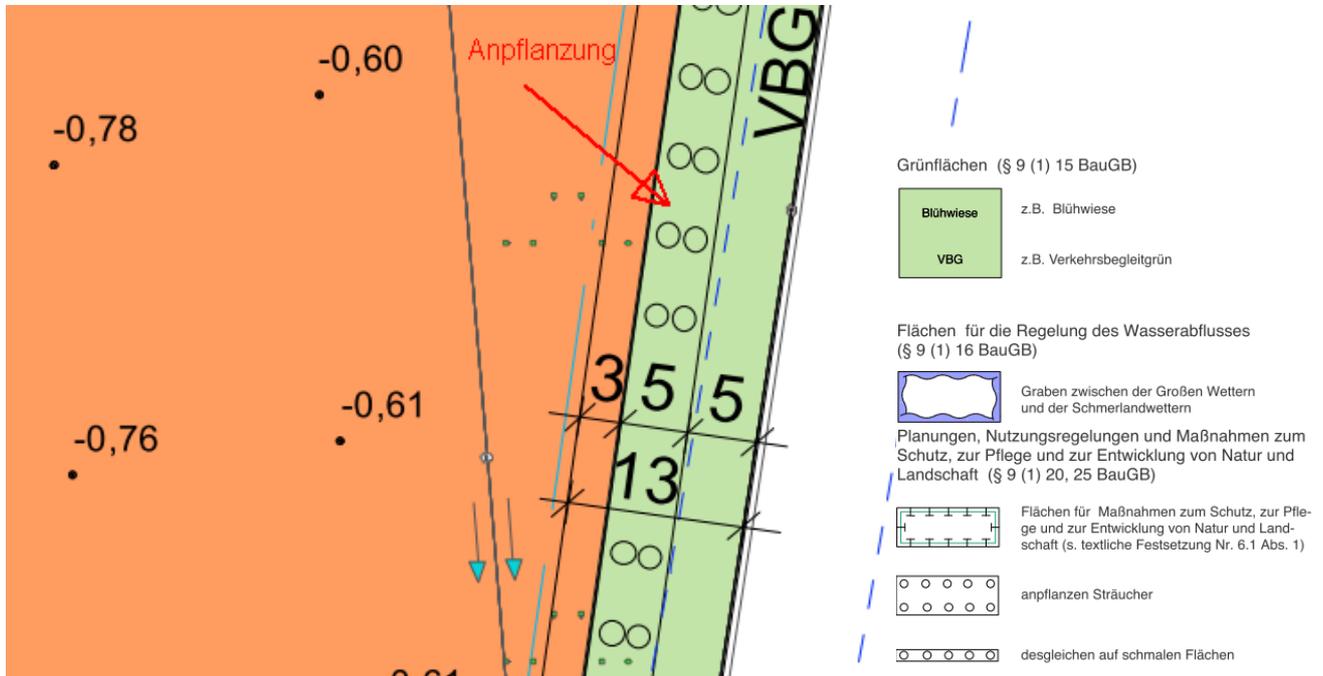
Detail/Ausschnitt (Quelle: Planungsunterlagen)
